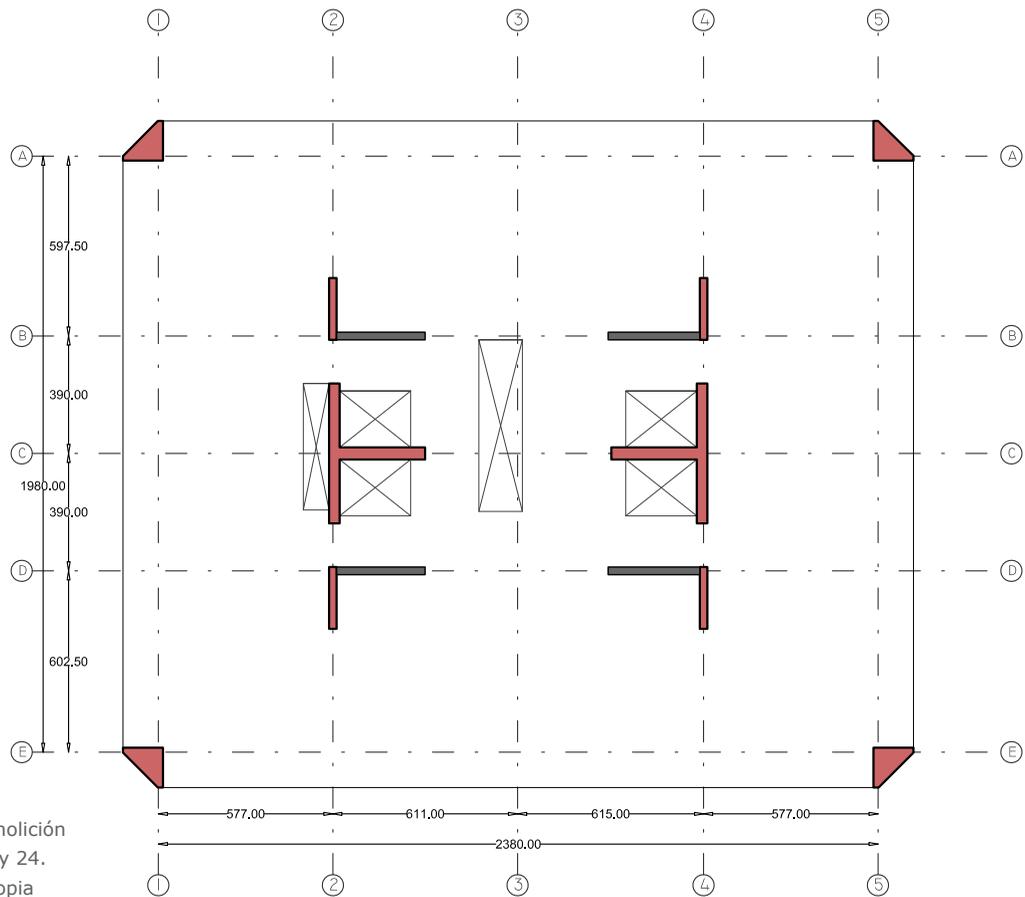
Demolición Muros Piso 23 y 24. Elaboración Propia
